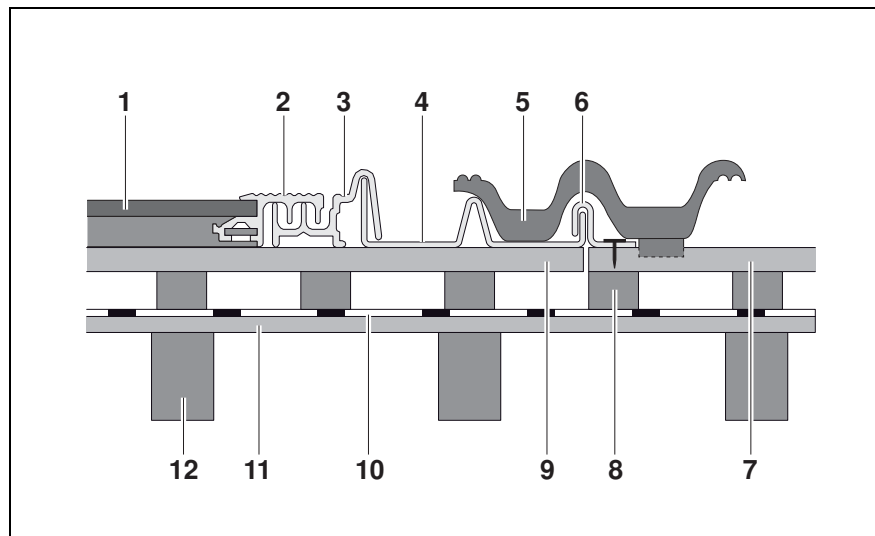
Raccordement de toiture sur un toit de tuiles (à droite)
